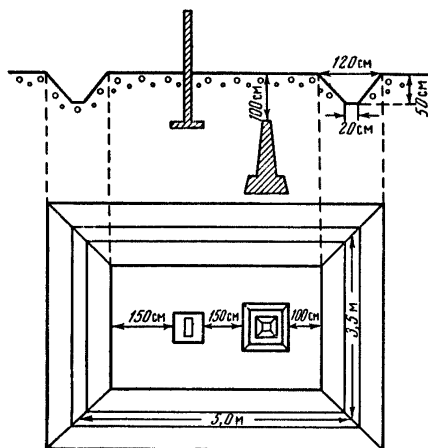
Наружное оформление фундаментального репера в зоне сезонного промерзания грунта
